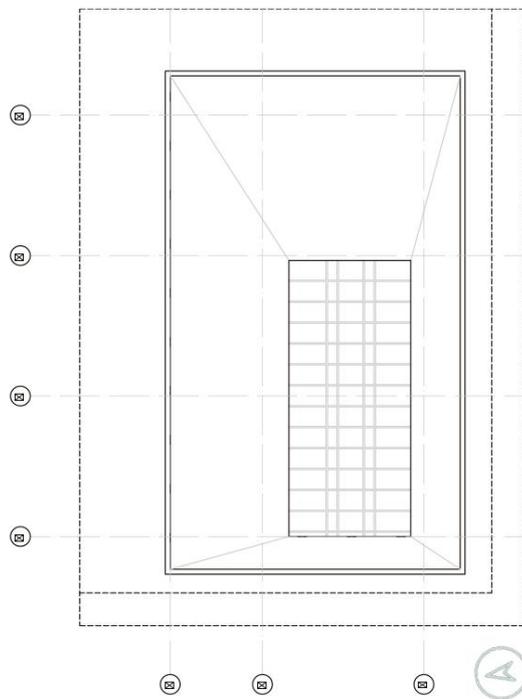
Plantas Alta 9- Planta Cubiertas
